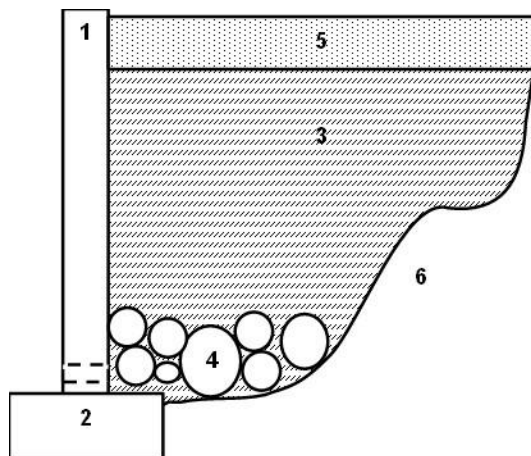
Схема террасирования с использованием подпорной стены: 1 – подпорная стена; 2 – фундамент; 3 – насыпной технозем; 4 – каменная забутовка с водоотводом; 5 – покрытия; 6 – засыпанный склон
